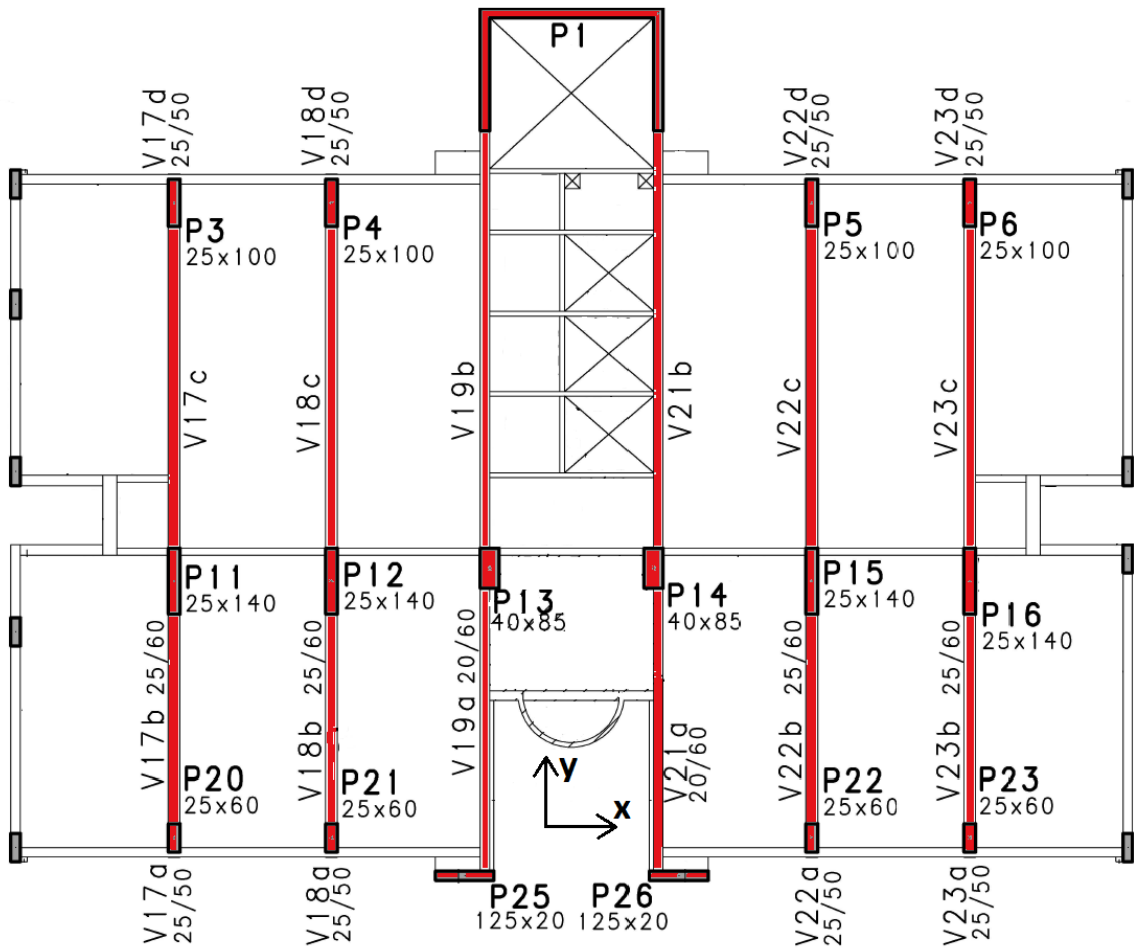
Indicação dos seis pórticos planos e direções ortogonais sobre a planta do pavimento tipo que possui maior repetição.
